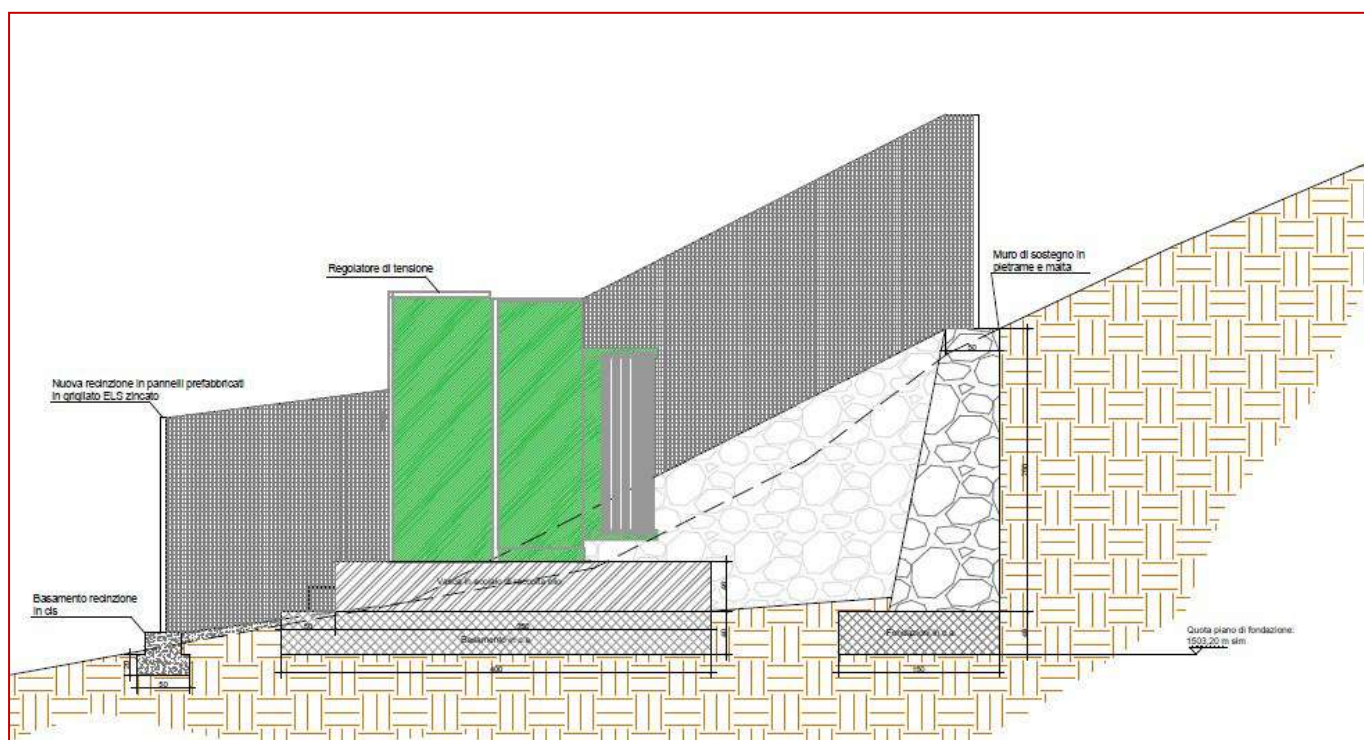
Estratto Elaborato 02 - Sezione tipo di progetto
